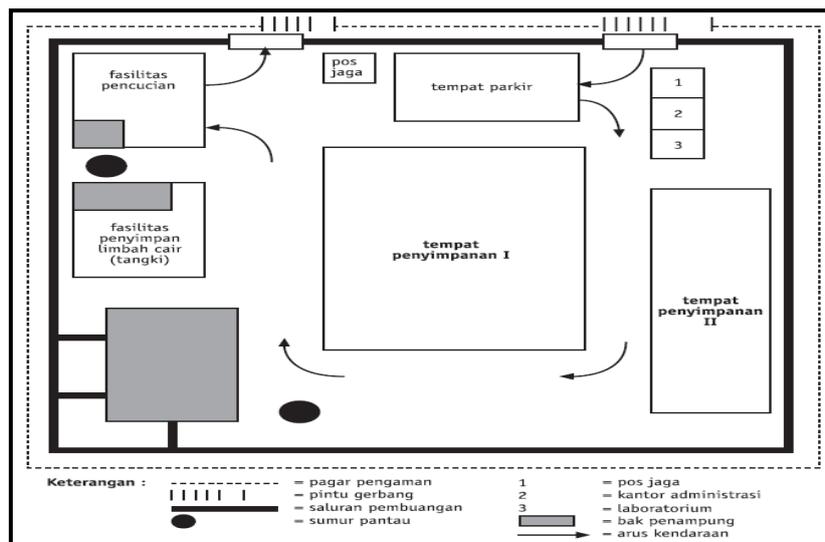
3 Tata ruang gudang penyimpanan Limbah B3
